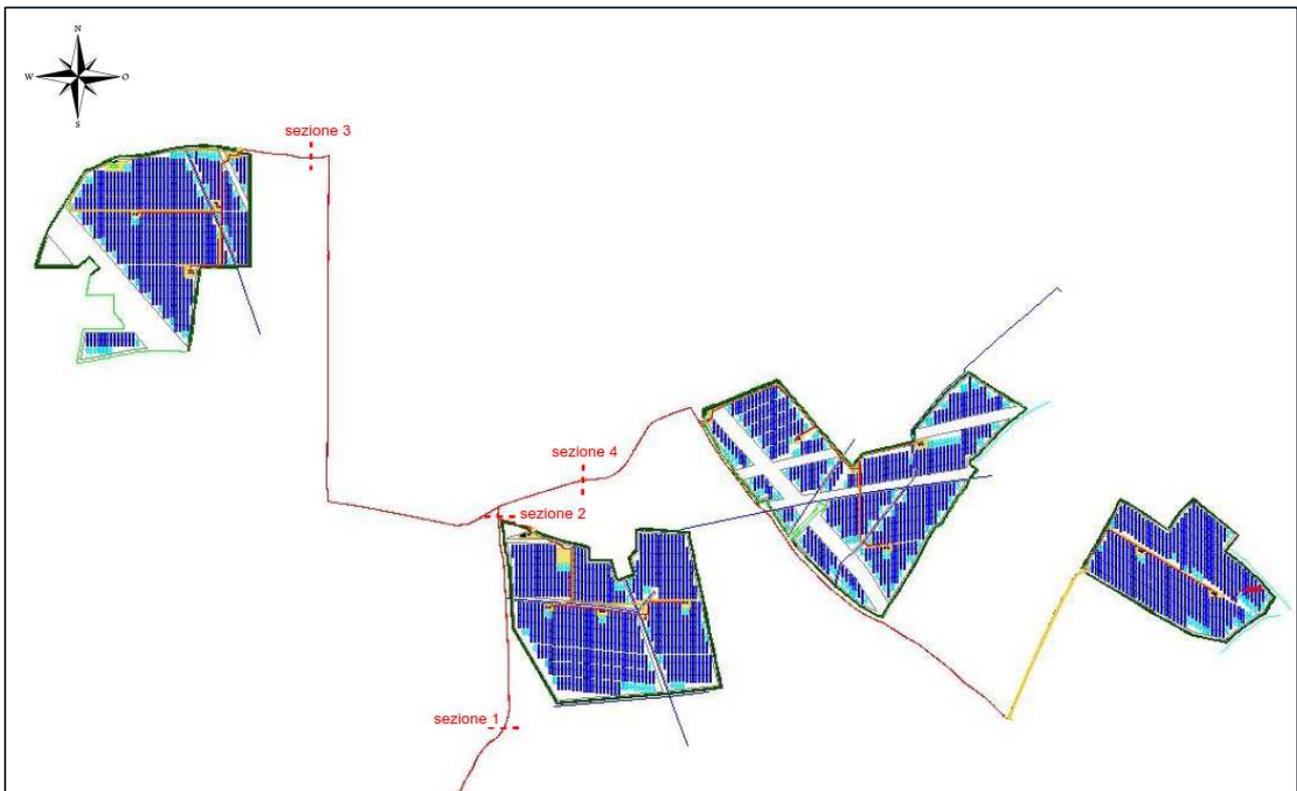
Planimetria impianto agro-fotovoltaico con le sezioni considerate
